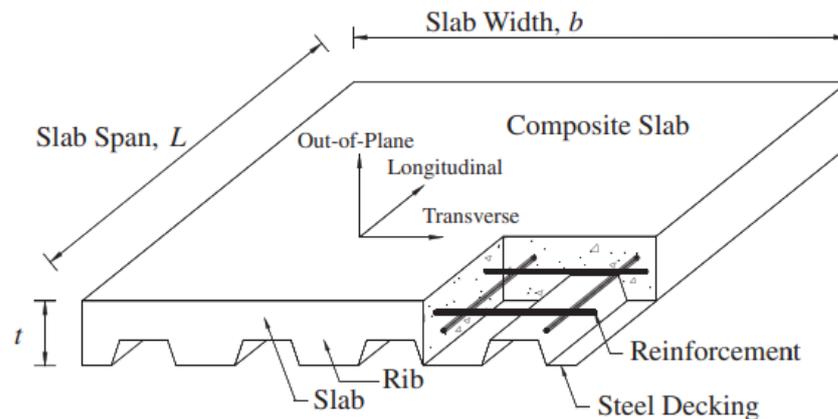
Losa colaborante Steel Deck (Gholamhoseini et al., 2014)
